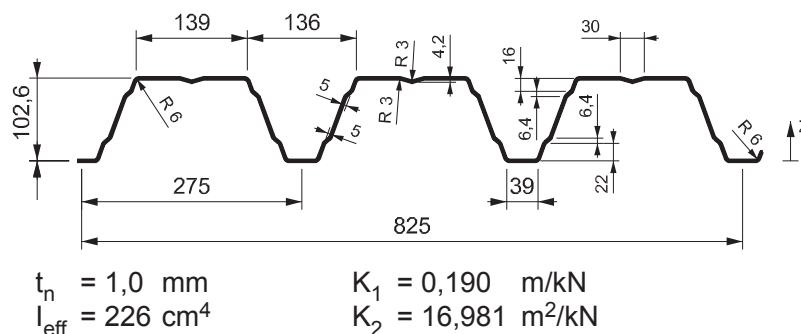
Hoesch Trapezprofil Typ T100.1, Positivlage
